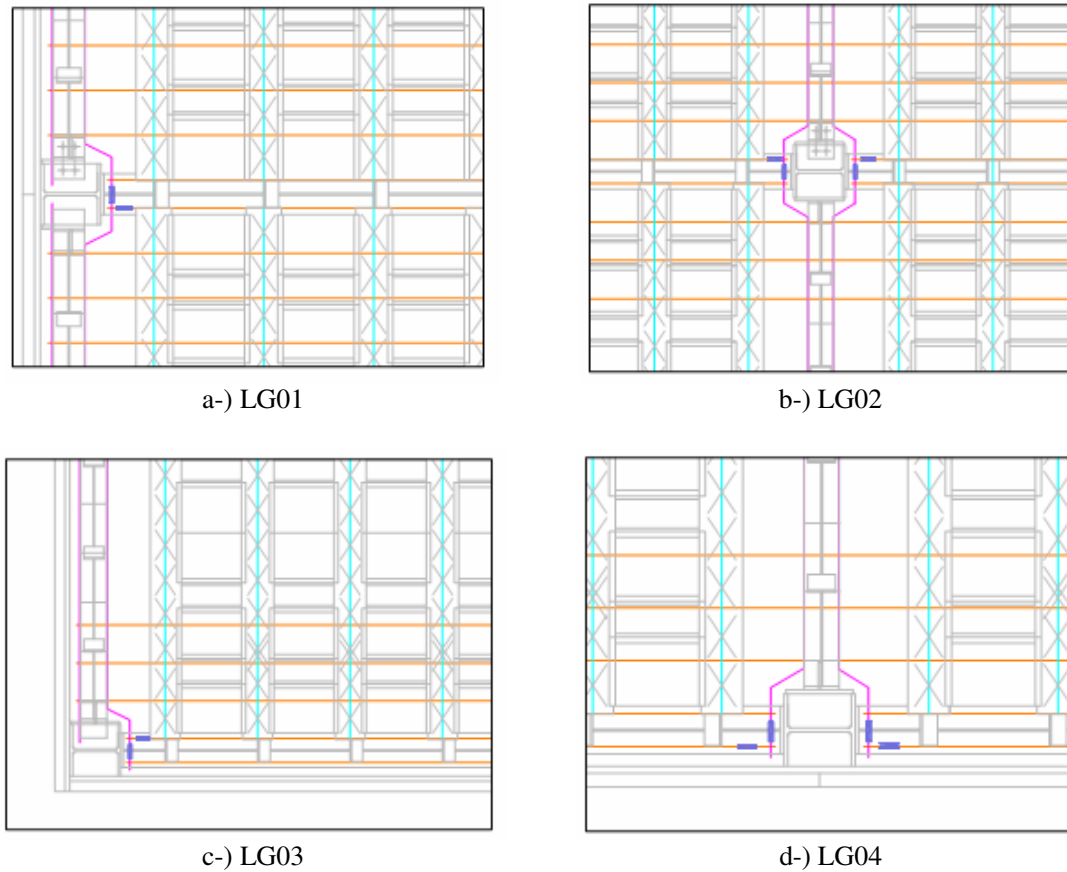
Posicionamento das armaduras de contorno e negativa longitudinal instrumentadas
